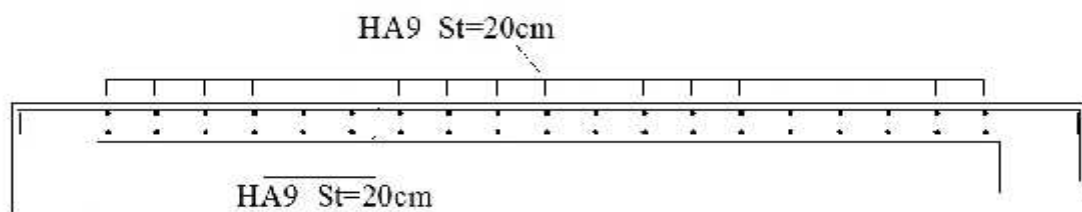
ferrailage de la dalle pleine dans le sens y-y
